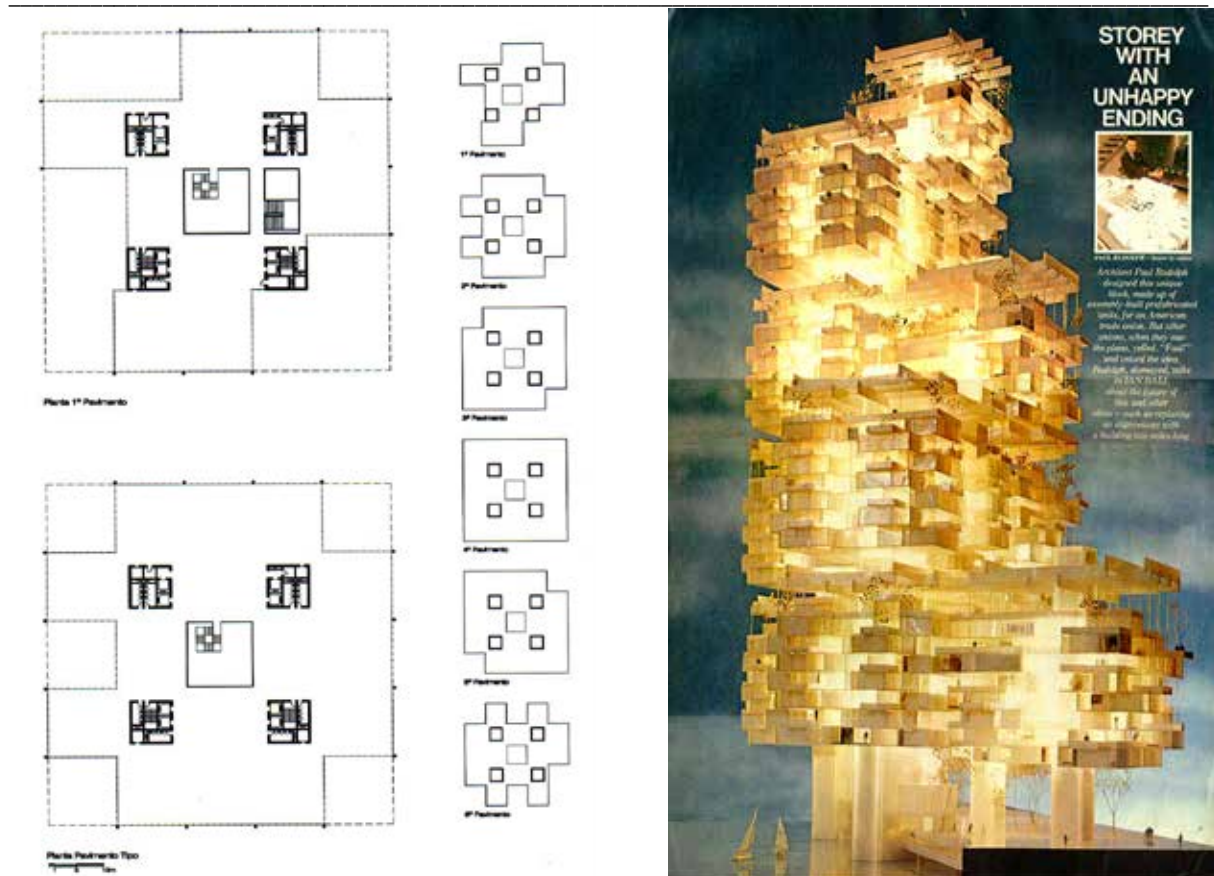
(coluna esq.) 1º prêmio BNDE DF; planta 1º pavimento e planta 6º pavimento; (centro) variação da tipologia dos pavimentos, verificada do 1º ao 6º andares.
